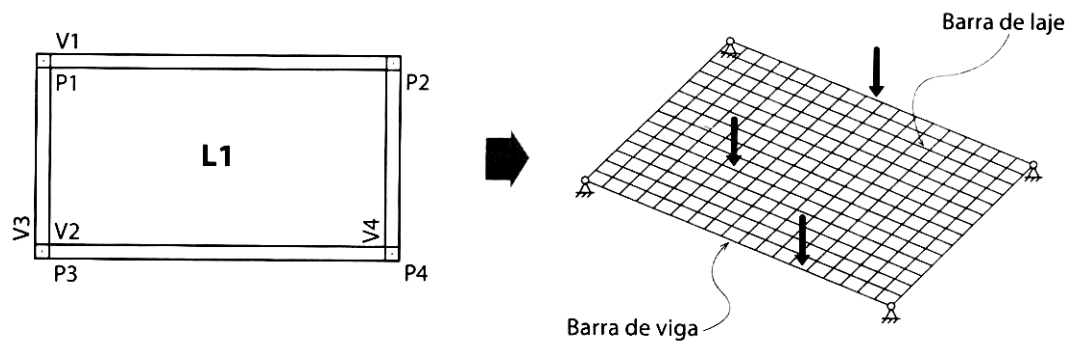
Discretização do pavimento (KIMURA, 2007).
